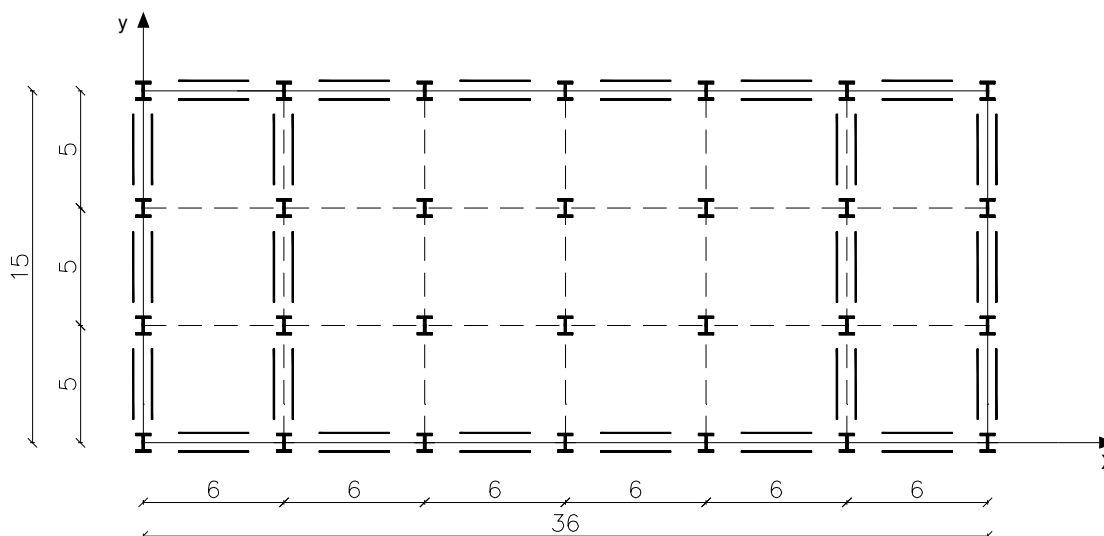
Pianta dell’edificio con in evidenza la disposizione dei *dispositivi isteretici a forma di stella*.
